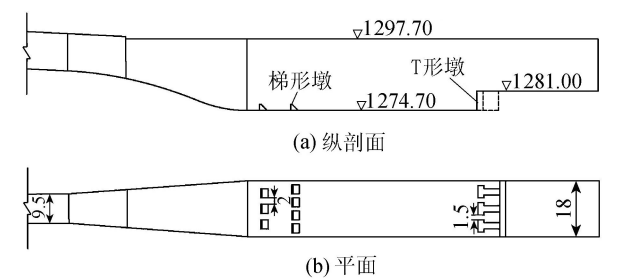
溢洪洞消力池原设计方案结构布置示意图(单位:m)
